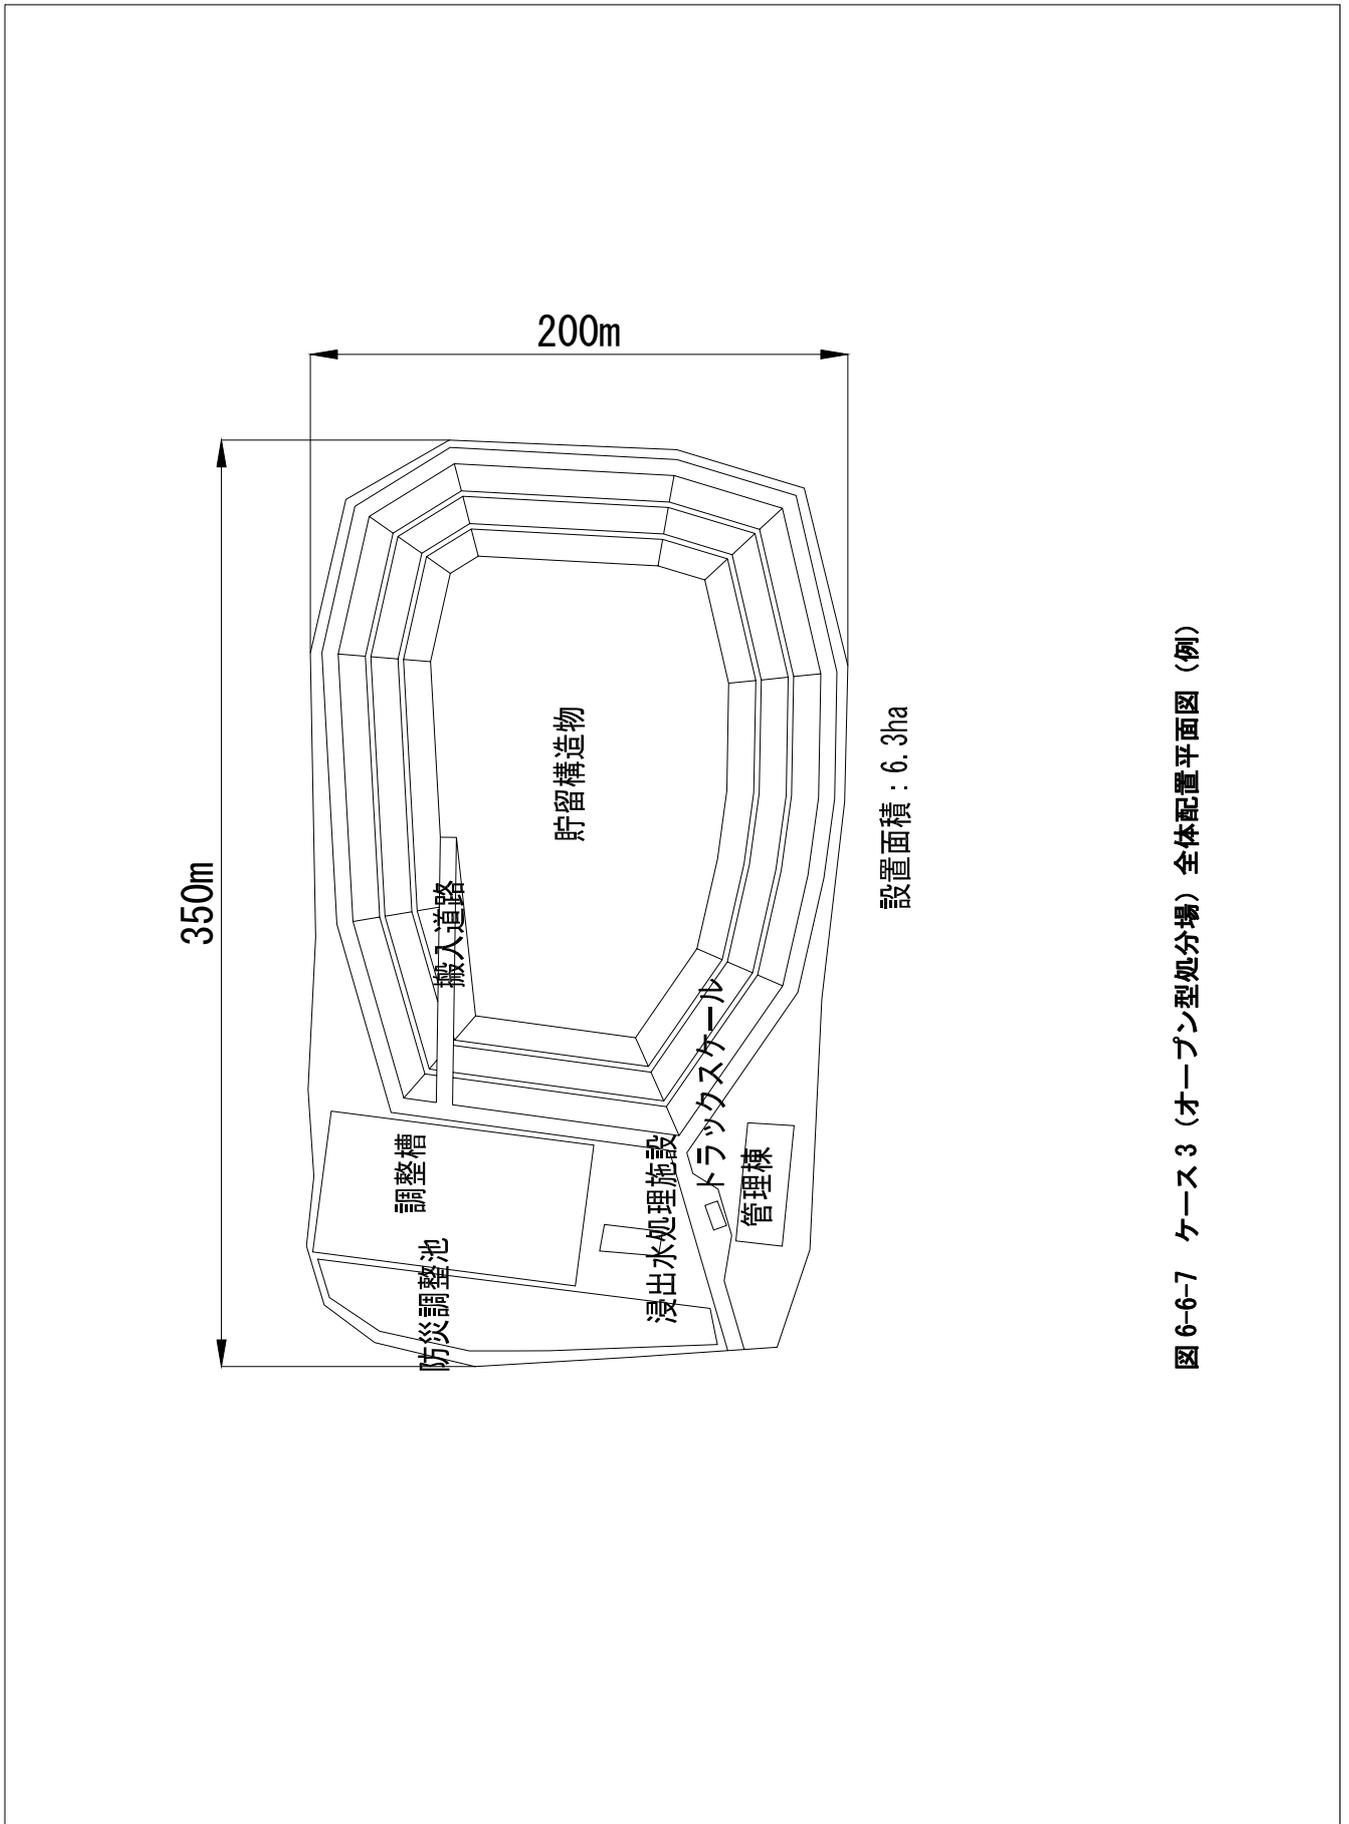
ケース 3 (オープン型処分場) 全体配置平面図 (例)
